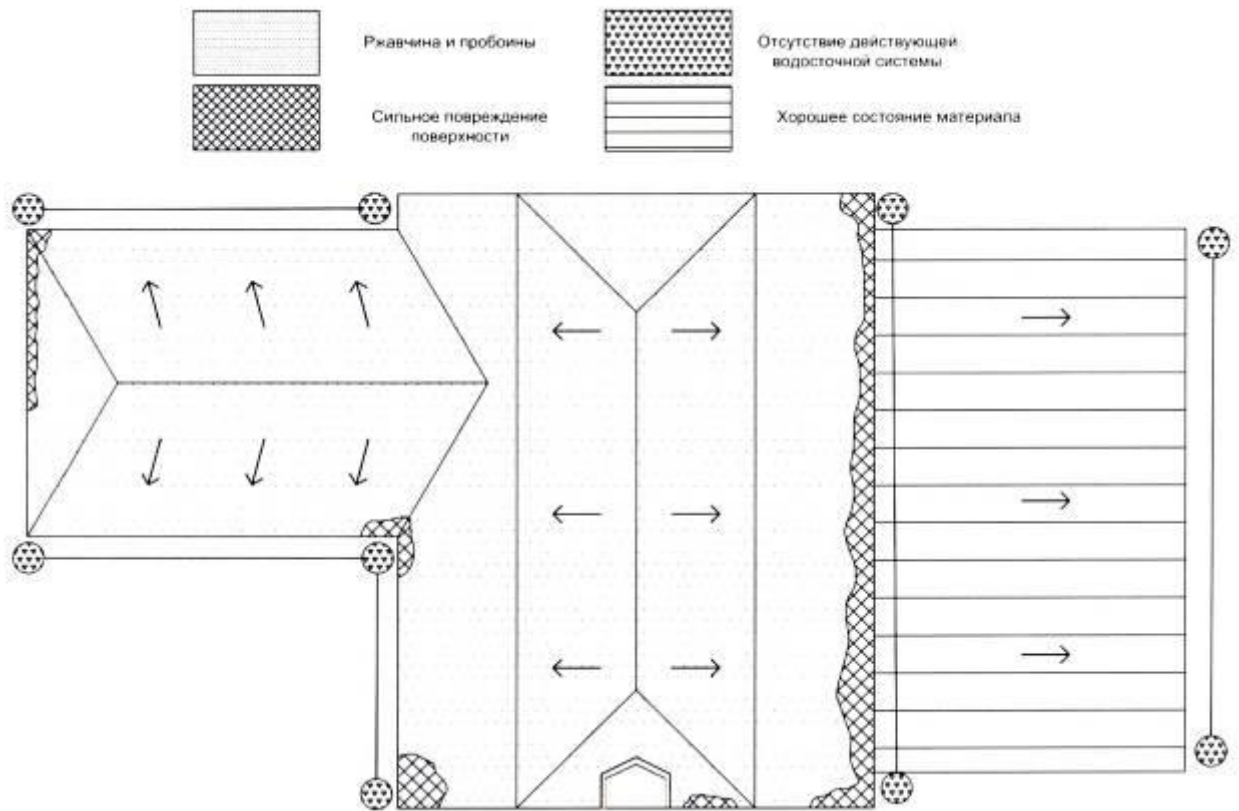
Дефектная карта фасада покрытия здания (пример)
